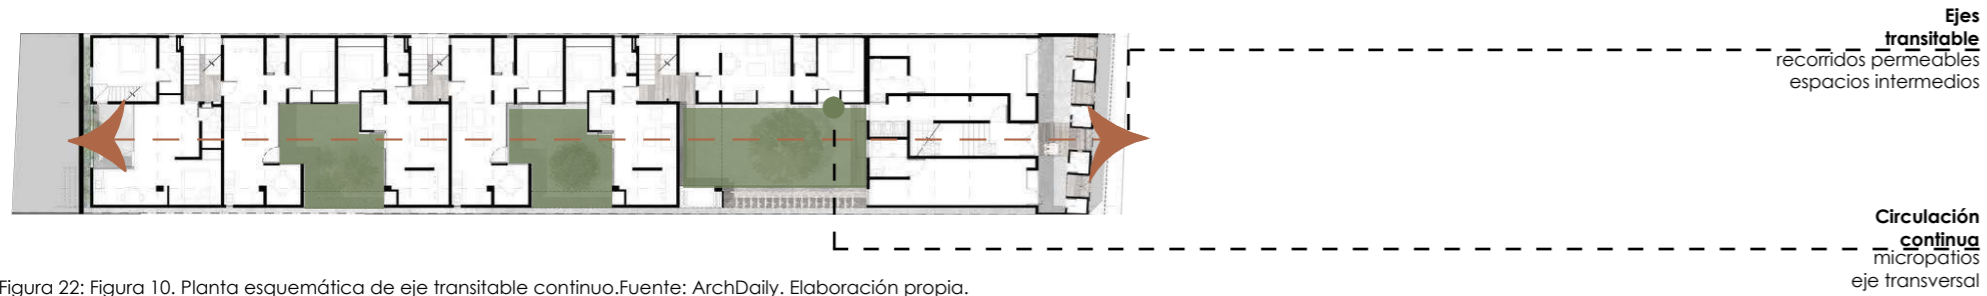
Figura 10. Planta esquemática de eje transitable continuo. Fuente: ArchDaily. Elaboración propia.
